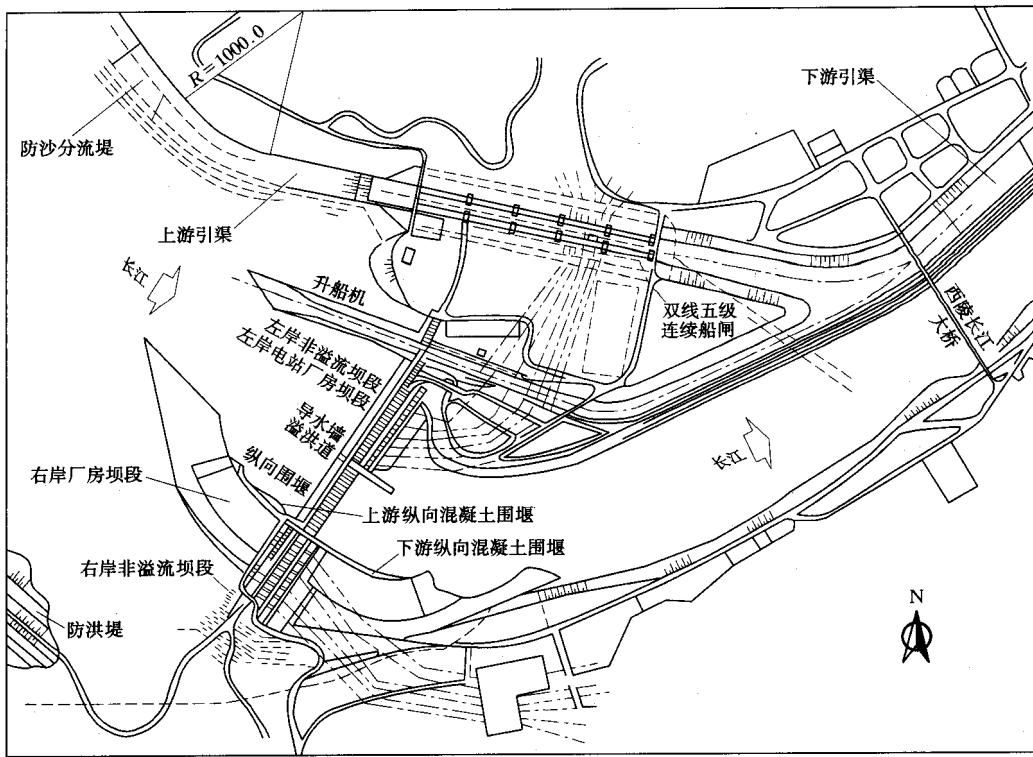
三峡工程枢纽平面布置示意图（单位：m）
